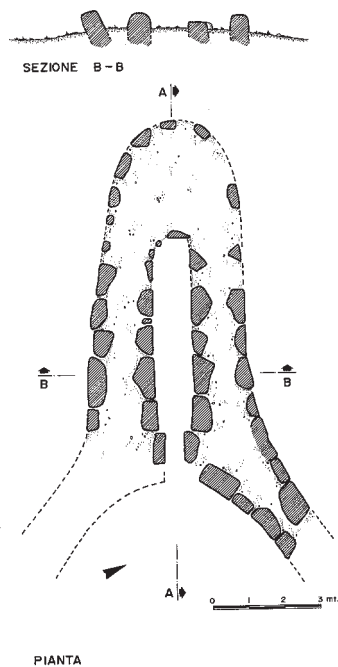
Birori, tomba di Sarbogadas C: pianta e sezioni.
